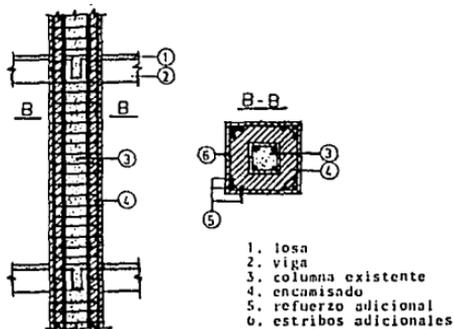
Encamisado de columnas a base de concreto reforzado.
